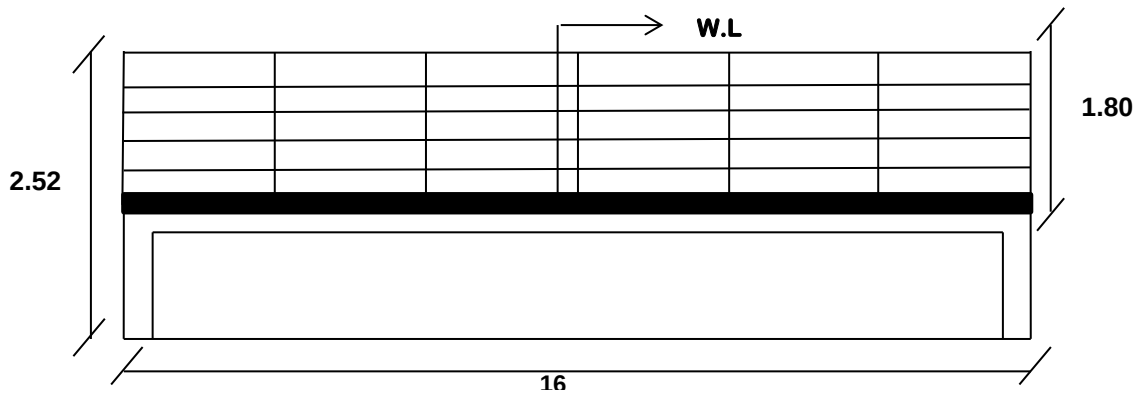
Punto de acción de la carga de viento sobre la carga viva (m).
